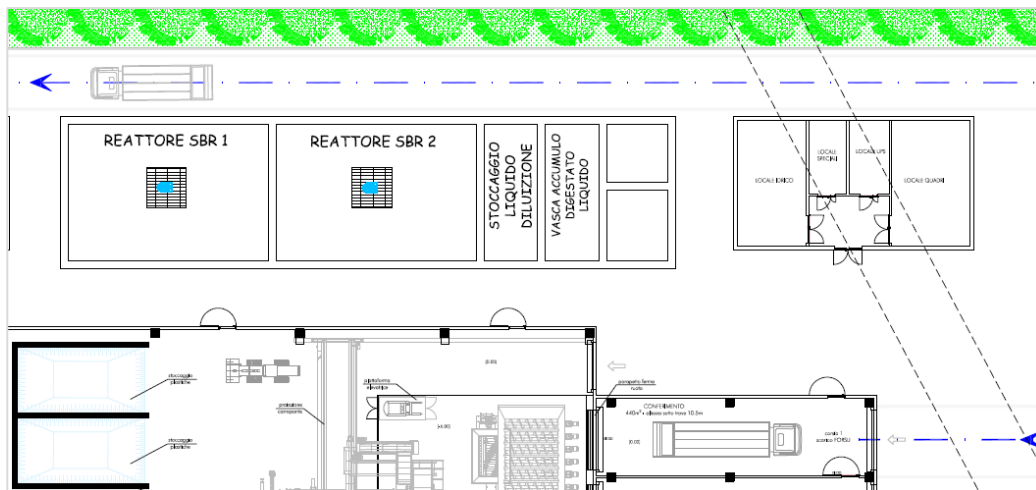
Compostaggio- Biocelle_ Stralcio dalla planimetria generale
